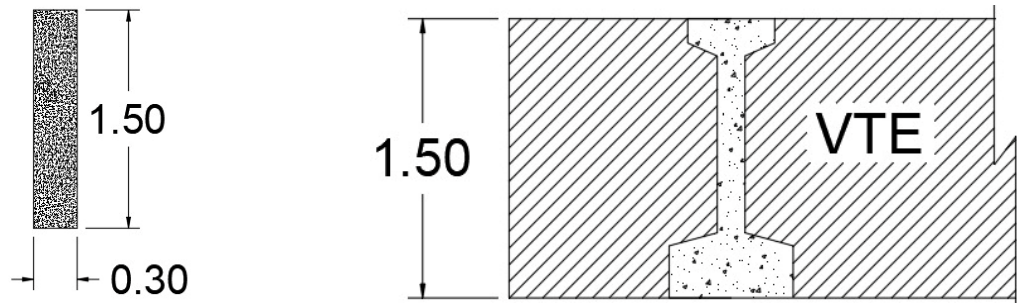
Sección trasversal de viga transversal extrema
